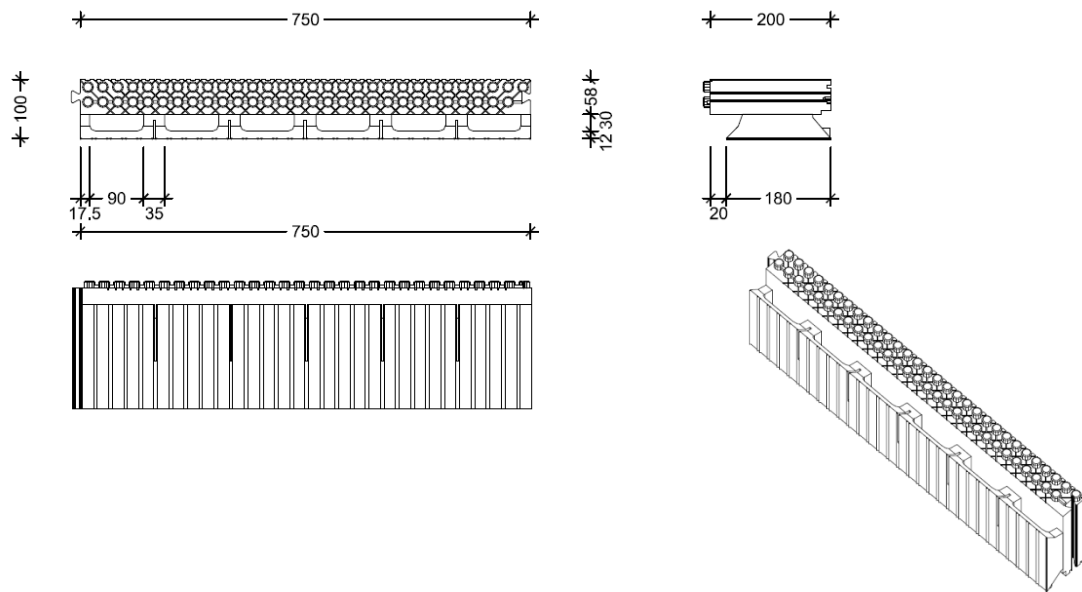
Dimensões de elemento de fecho de laje (ARGISOL, 2010).
